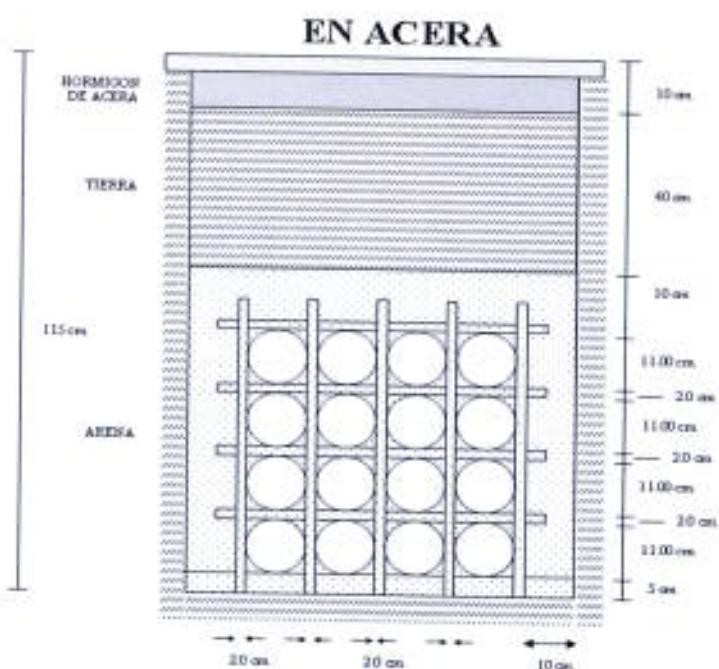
colocación de ductos PVC en acera, 16 vías
